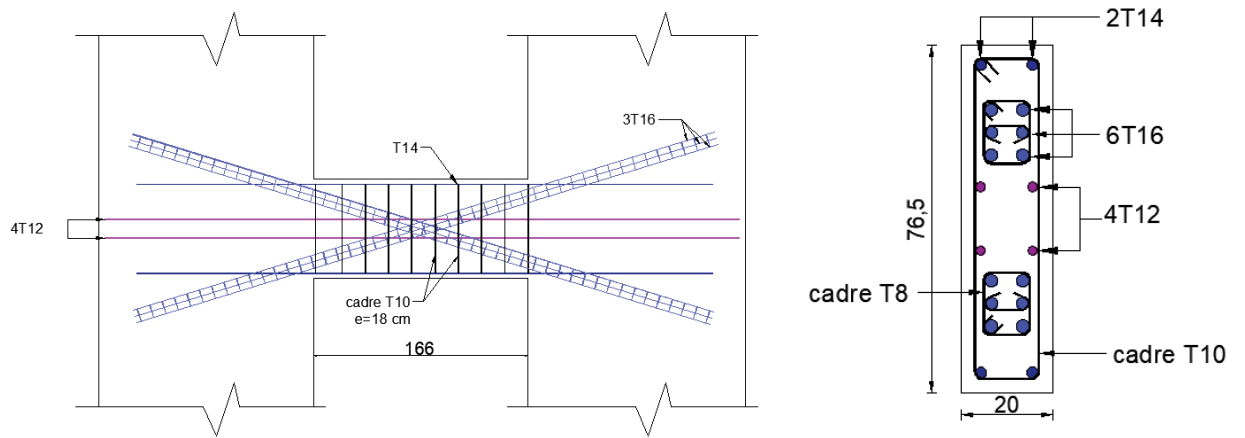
schémas de ferrailage du linteau 1 et 1'
